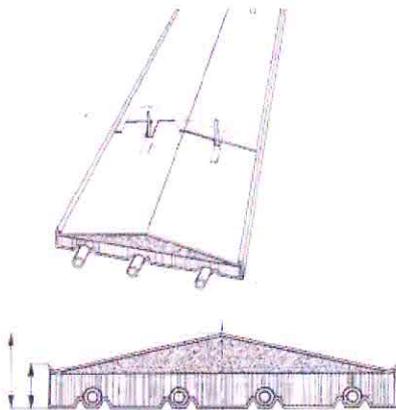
Deckenstrahlplatte mit Ballwurfschutz (Quelle: Sunline)
